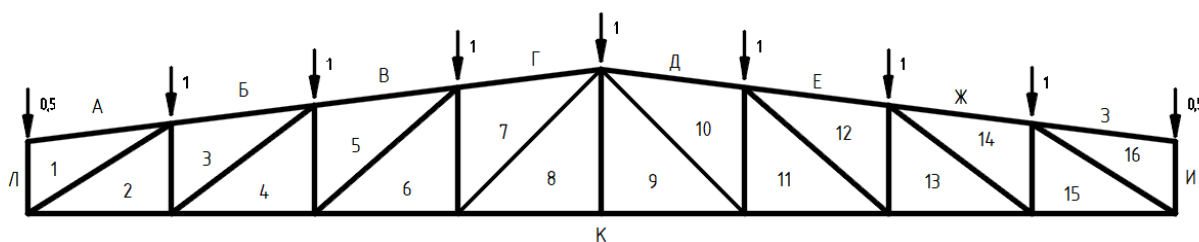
Схема узловых нагрузок на стропильную ферму
